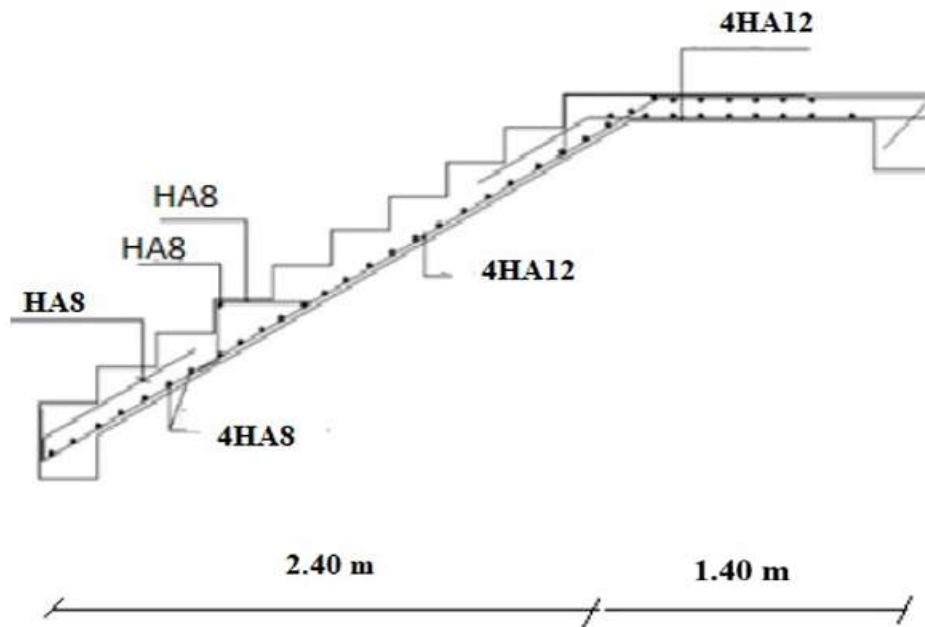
Ferrailage du volée 1 et 2 de l'escalier
